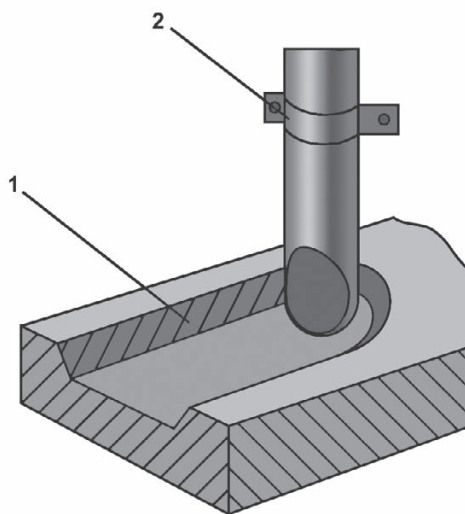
Бетонный желоб для водоотведения: 1 — бетонный желоб; 2 — упор
